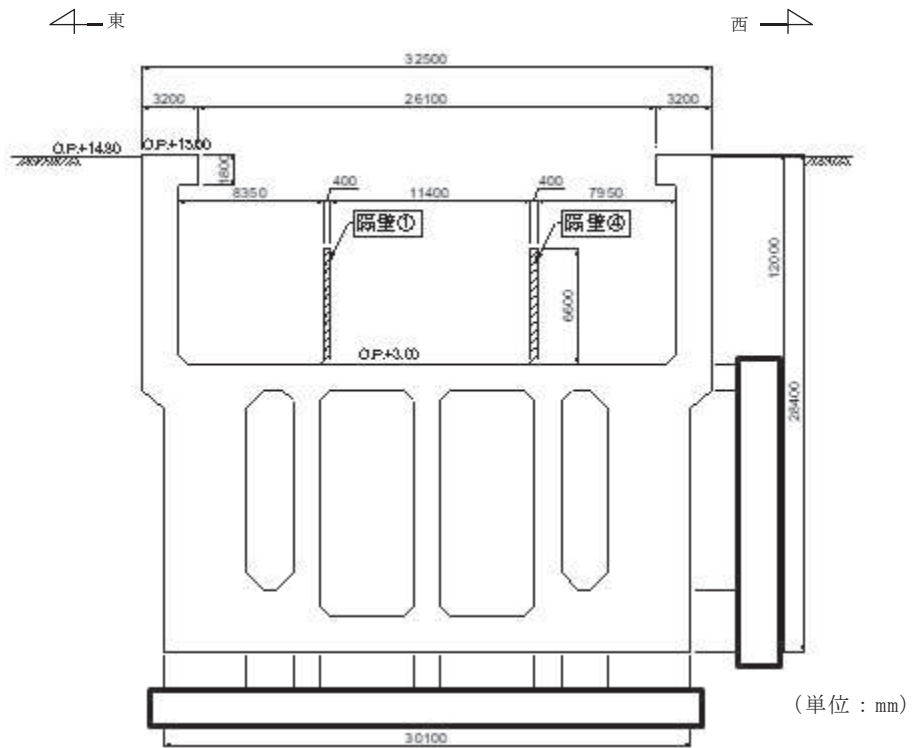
(1) 補機ポンプエリア断面図 (①—①断面)
